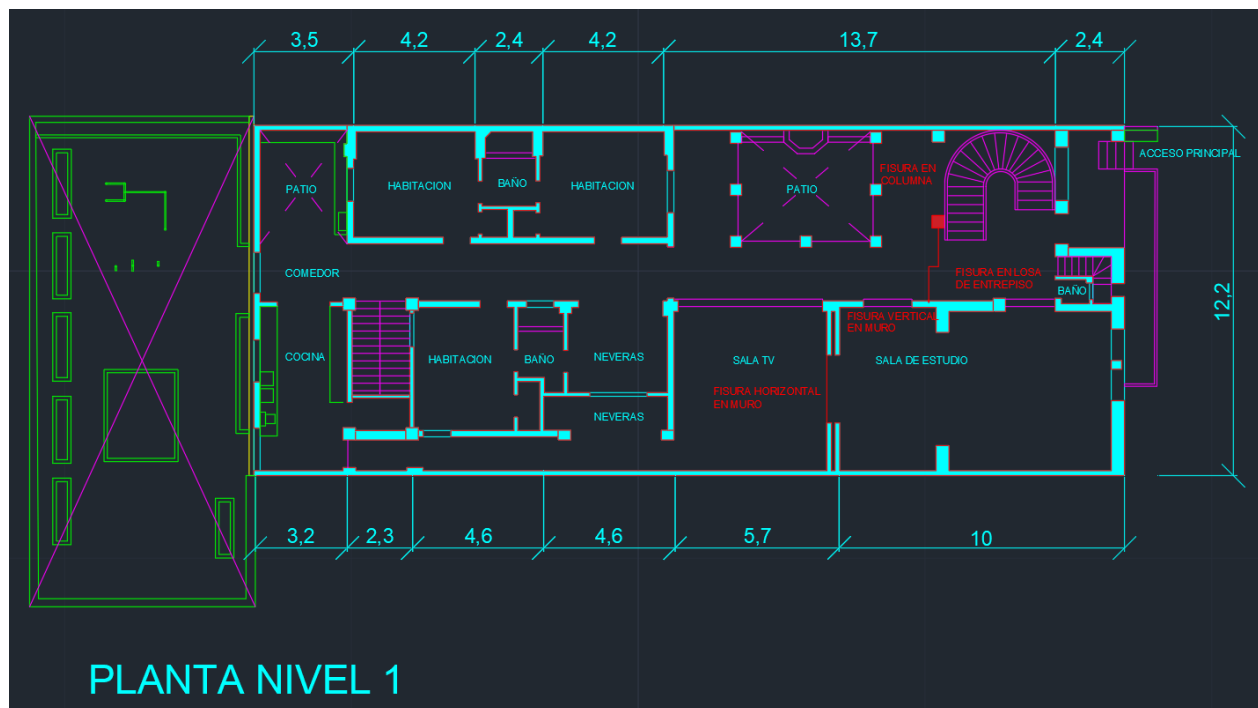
Fisuraciones en la planta del nivel 1. Elaborado por los autores, 2024.
